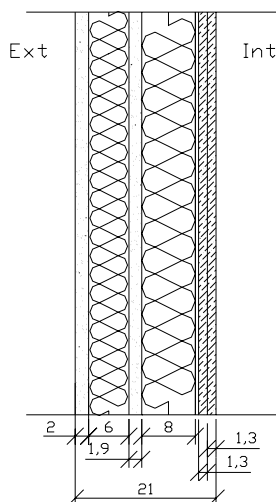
Parede dupla leve com reboco plástico armado sobre isolamento aderido
